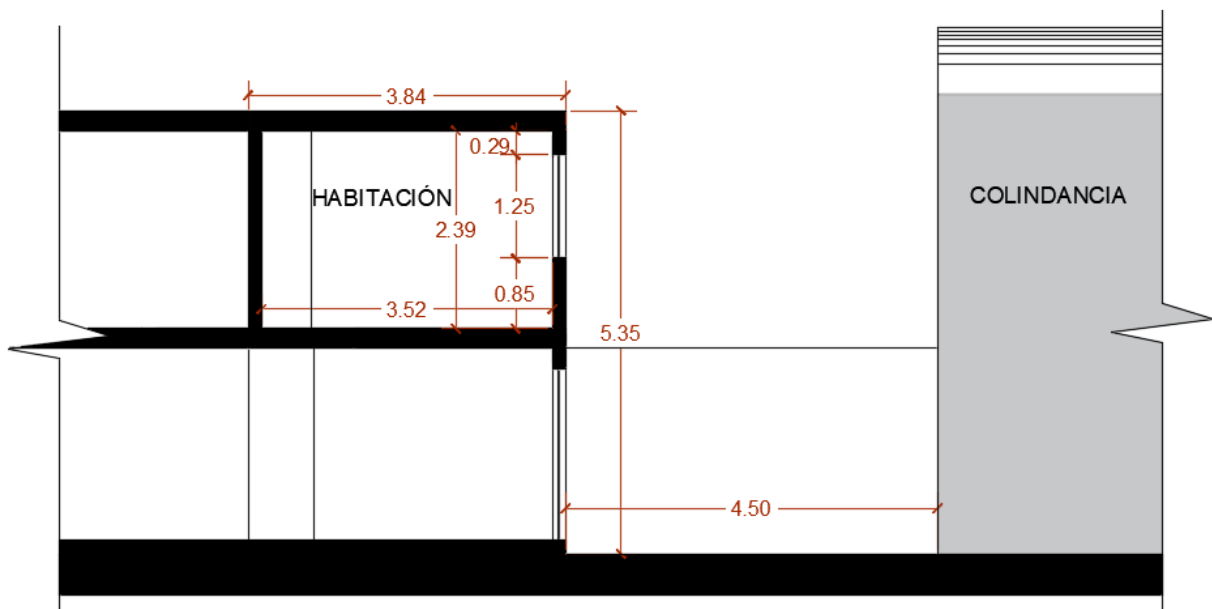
Corte arquitectónico de distancia a otro edificio. Fuente: Elaboración propia del autor.
